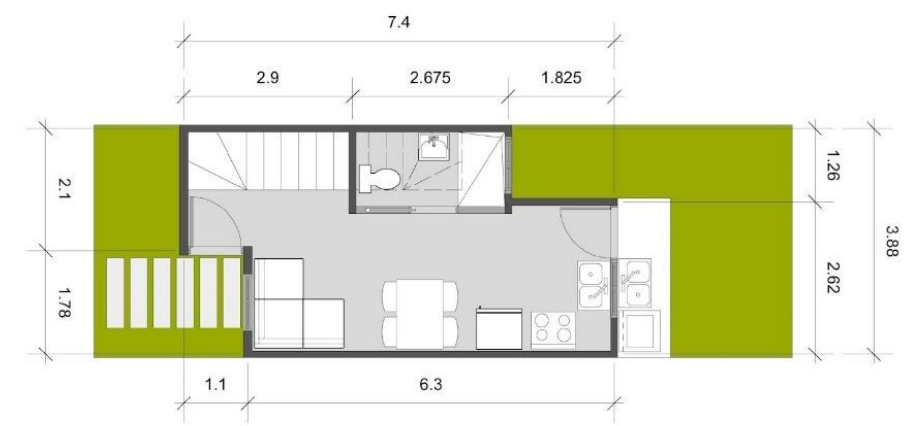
Planta Primer Nivel Residencial El Faro. Fuente: INVU. (2016). Plan Integral de Intervención San Francisco de Heredia, Pág. 24.
